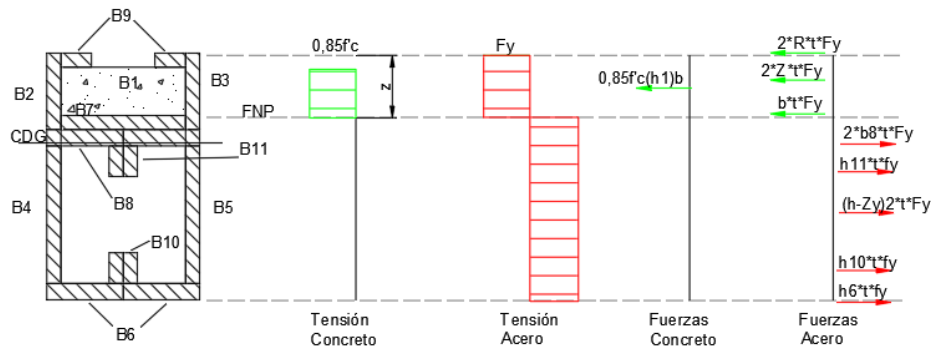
Distribución de tensiones y fuerzas en la Sección N°3 en el rango plástico.
